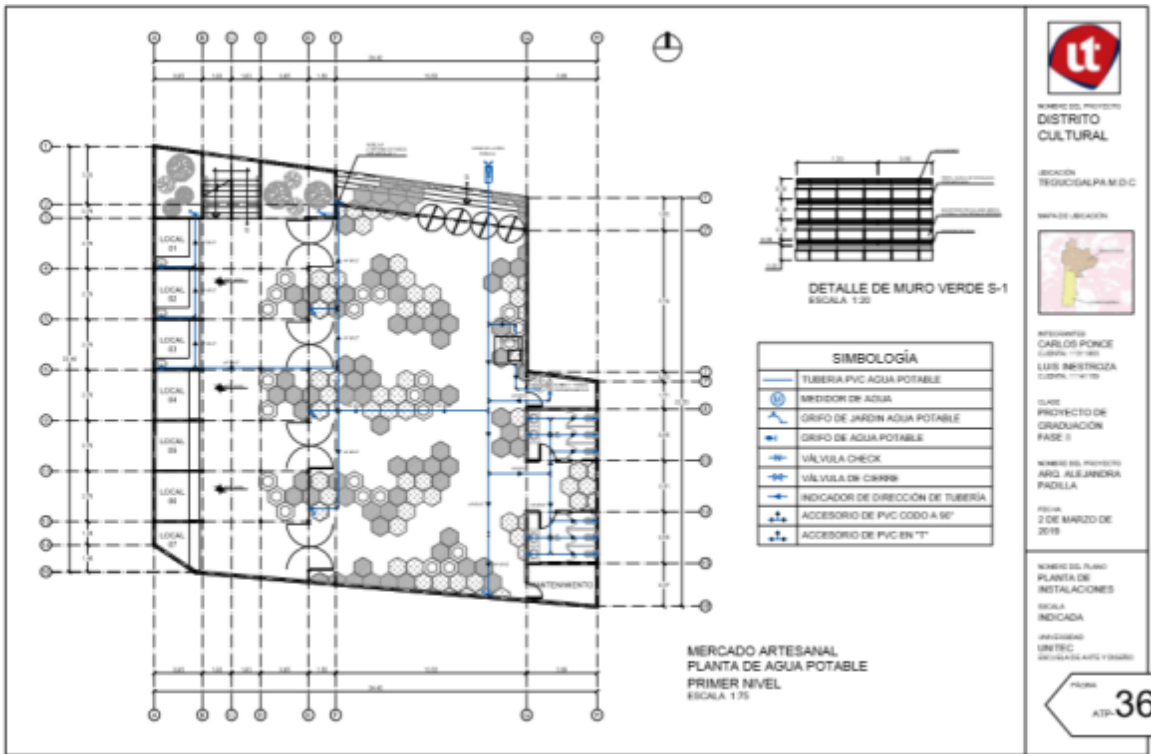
Planta de Agua Potable Mercados Artesanal
